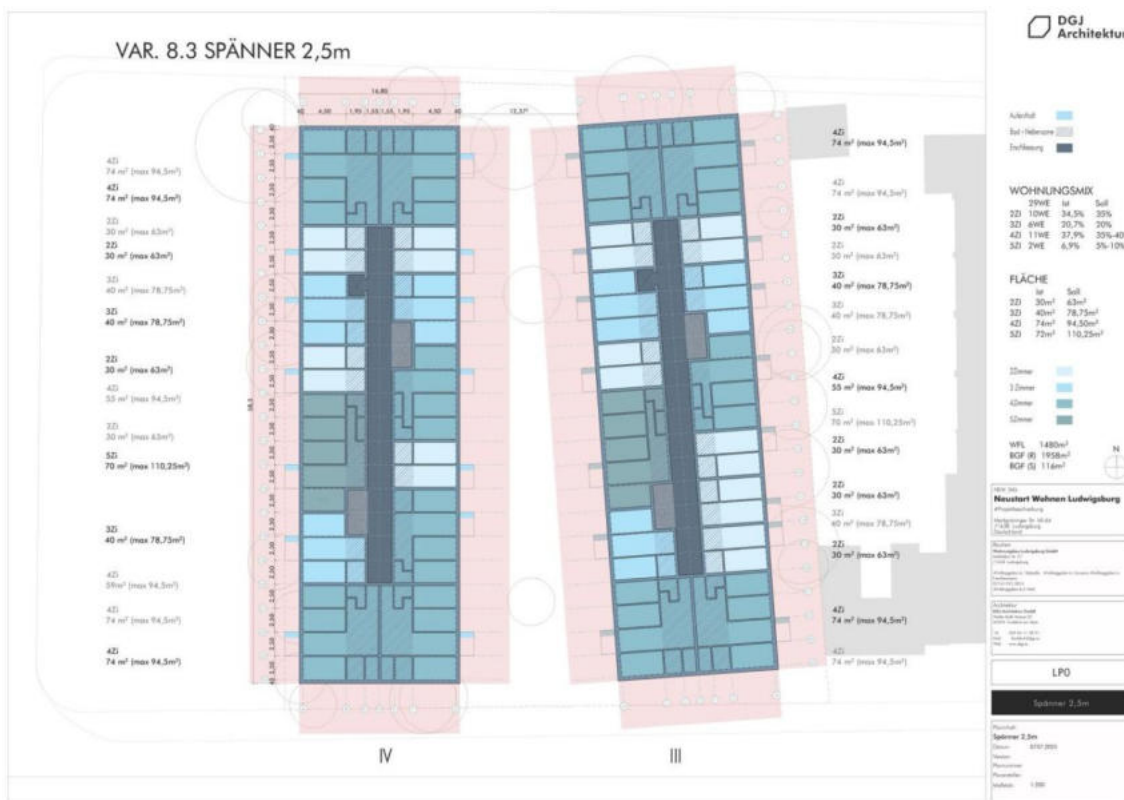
Spänner R 2.5*, Gebäudetiefe 16,8 m, Grundrisse des gesamten Grundstücks ohne Maßstab. DGJ Architektur GmbH, 2025
